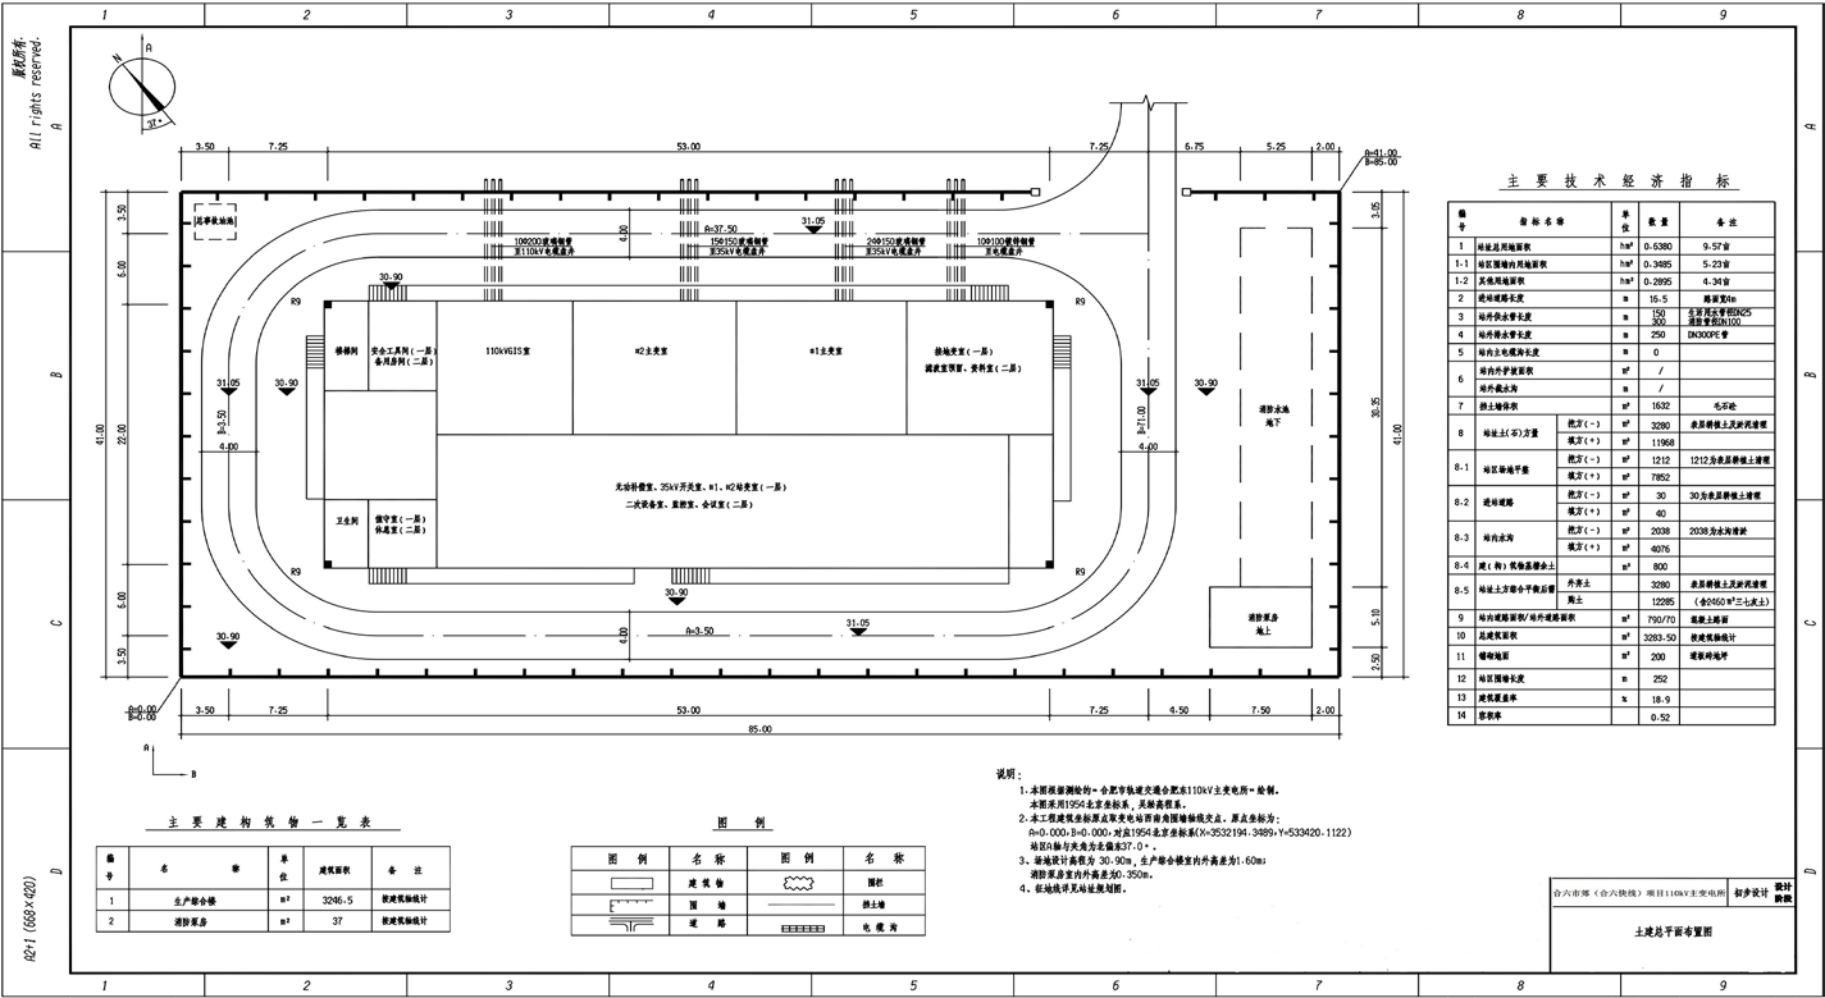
合六市郊（合六快线）项目 110kV 主变电所总平面布置图
